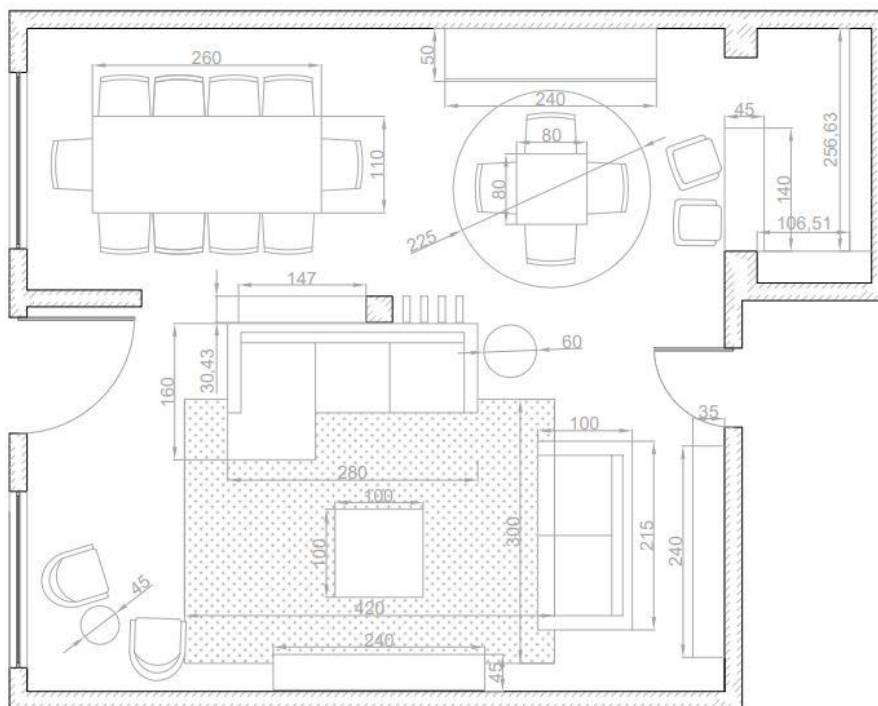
Planta de Equipamento Cotada Projeto Lino
